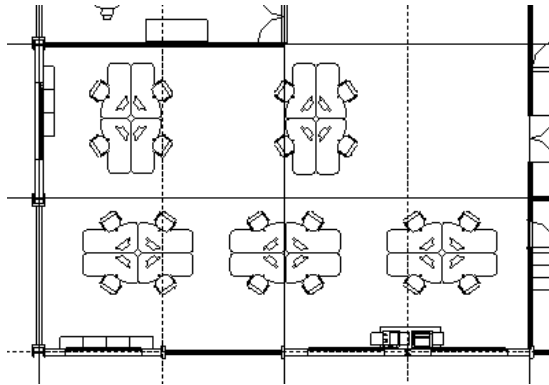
Vista de planta de la disposición de los escritorios para los trabajadores.
